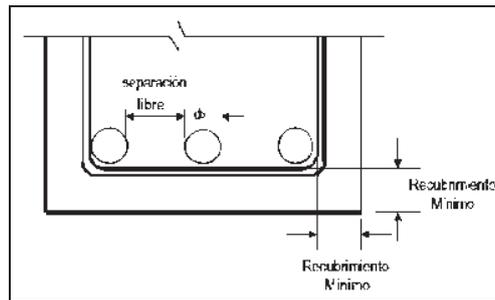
Recubrimiento y separación libre de varillas y torones [3].
